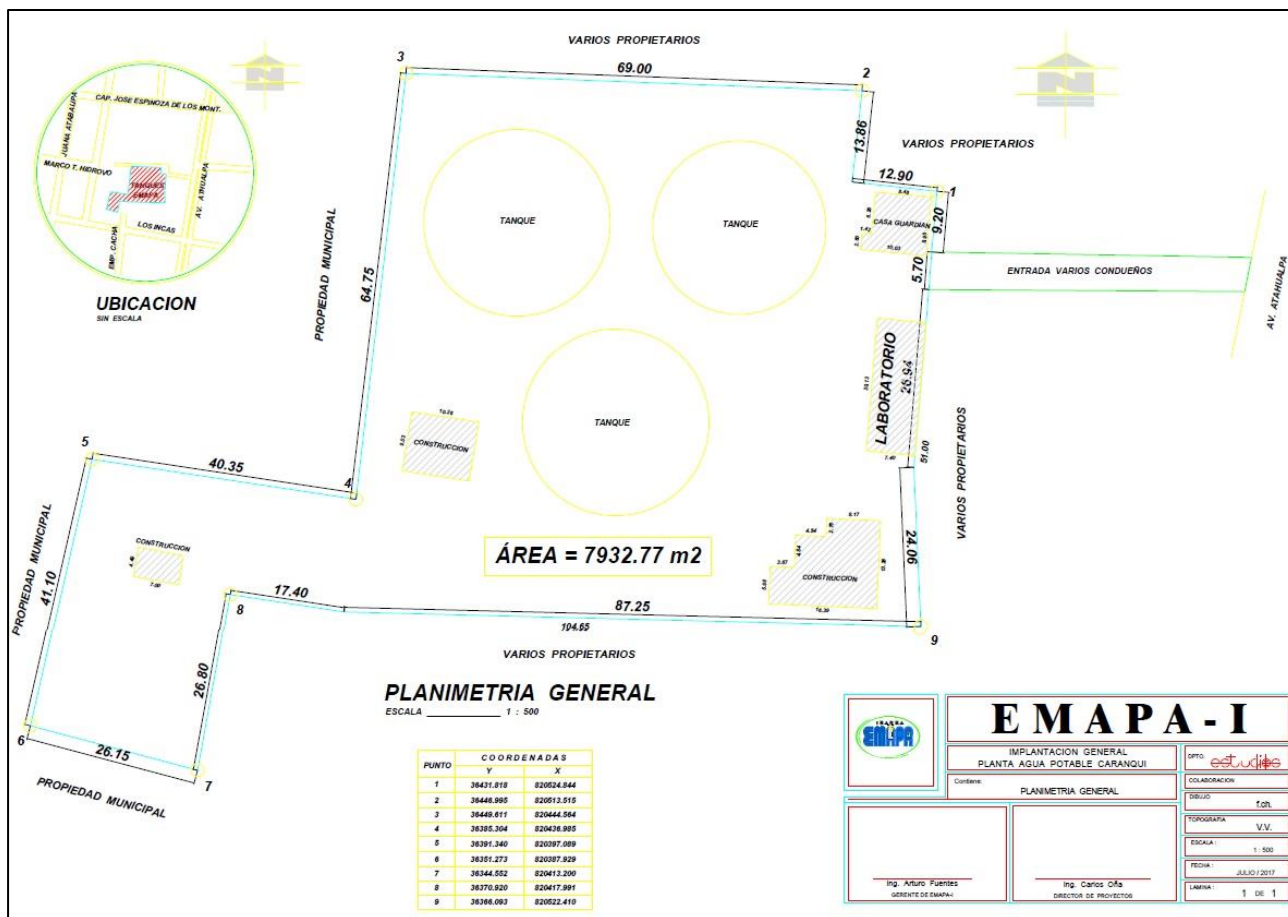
Planimetría General Planta de Caranqui EMAPA-I
